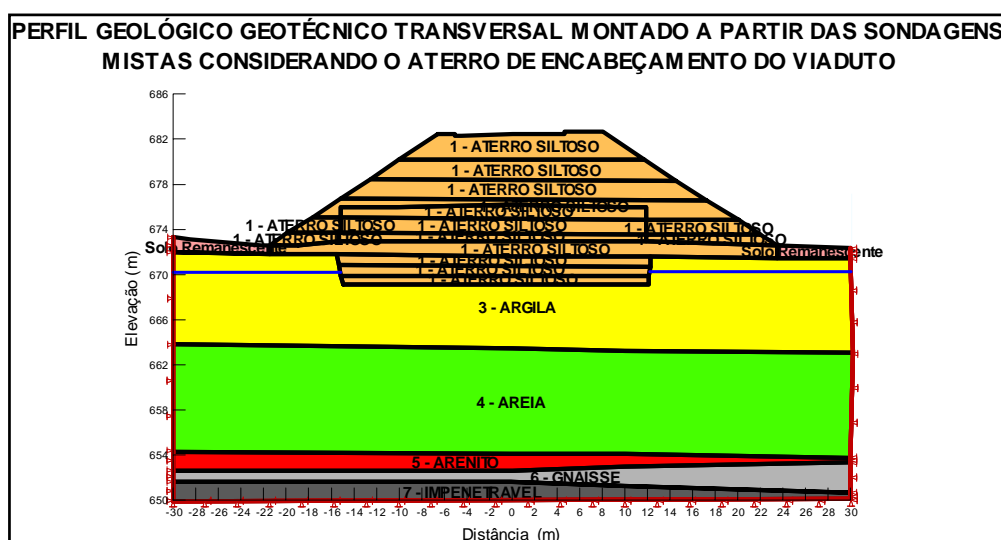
Perfil transversal do conjunto aterro e solo de fundação do aterro.
